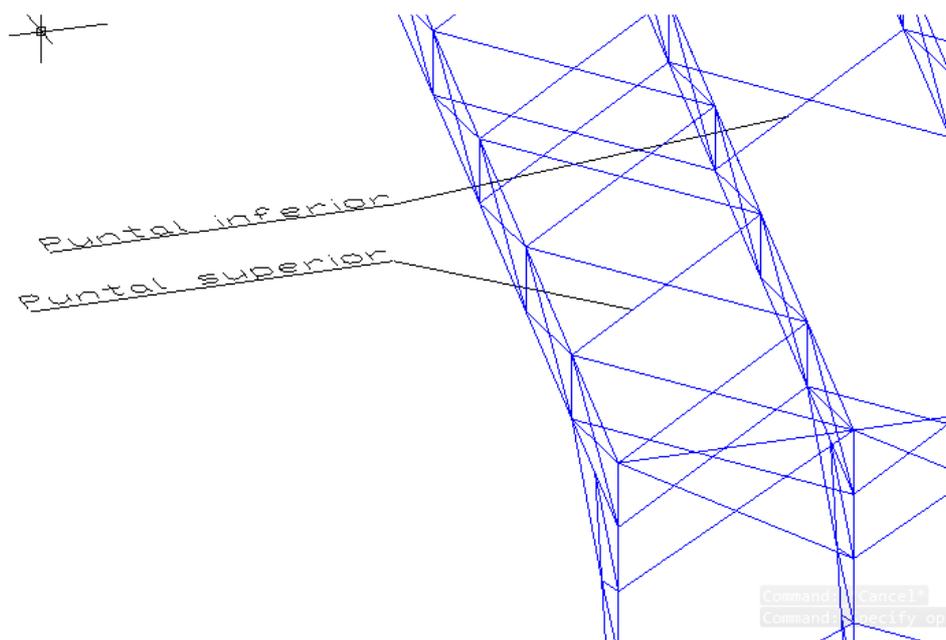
Detalle vista superior elementos estructura marcos rígidos.
